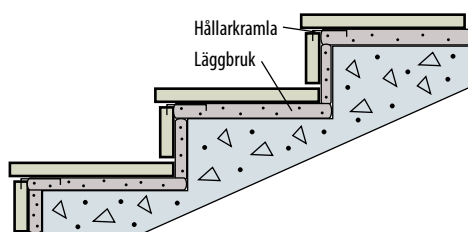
Beklädnadstrappa monterad i bruk på stomme av betong. Typkonstruktion T4
